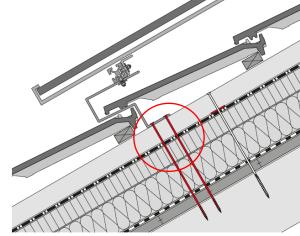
Die Schrauben der Dachhaken reichen bis in den Sparren. Diese Durchdringungen müssen mit Nagelbändern/Nageldichtungen abgedichtet werden.
